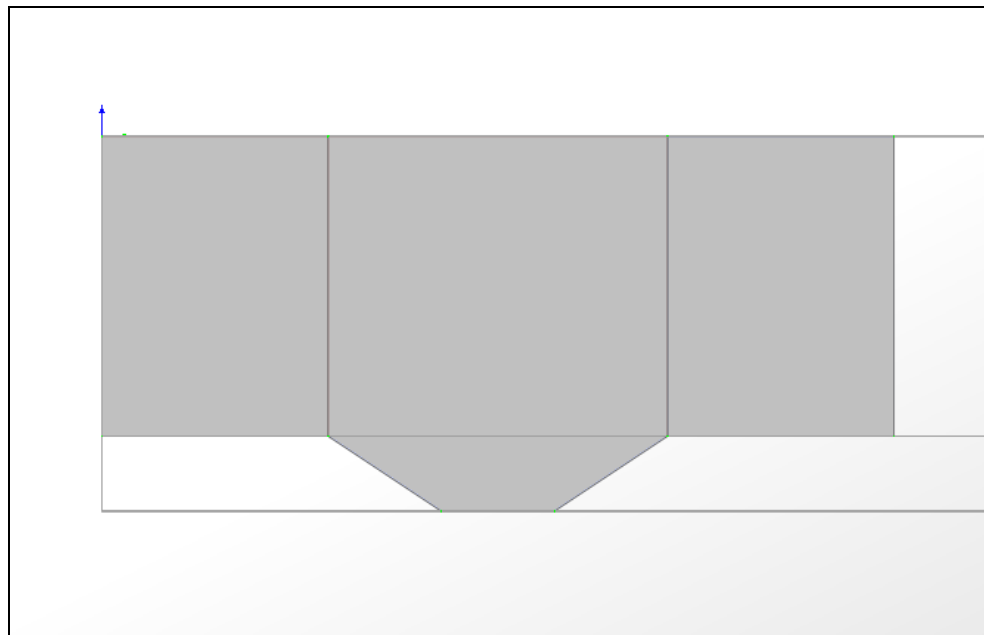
Elaboración de sección transversal concreto entrepiso solido
